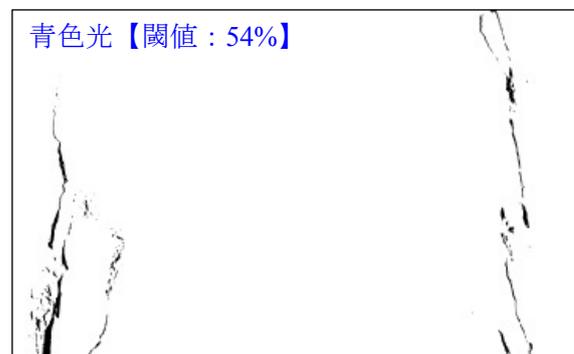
写真-1の供試体からひび割れを抽出した二値化画像
